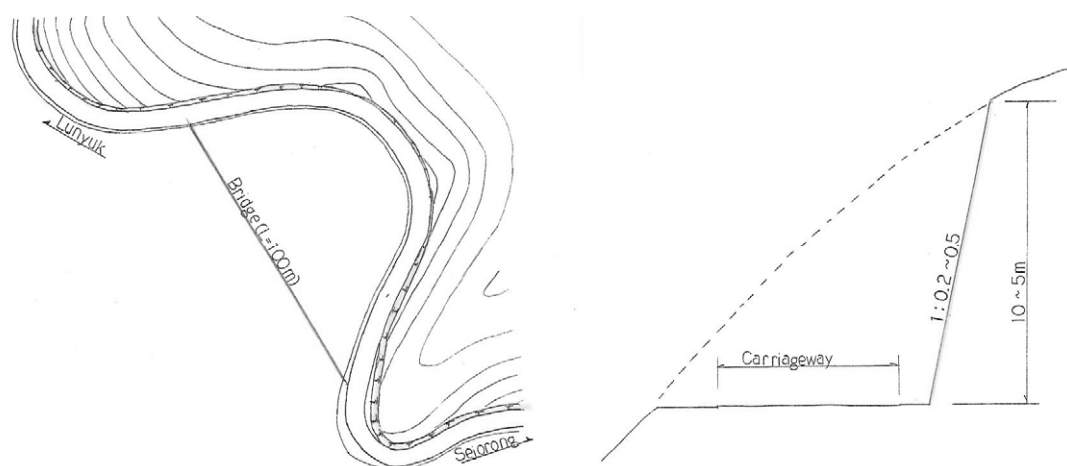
線形改良箇所（BR-5）の概略平面図・横断図
